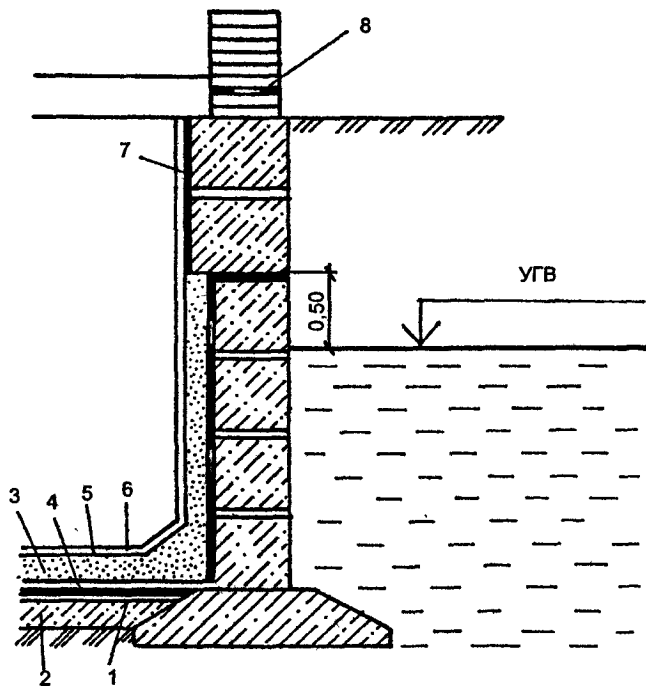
Гидроизоляция подвала при больших напорах грунтовых вод:
